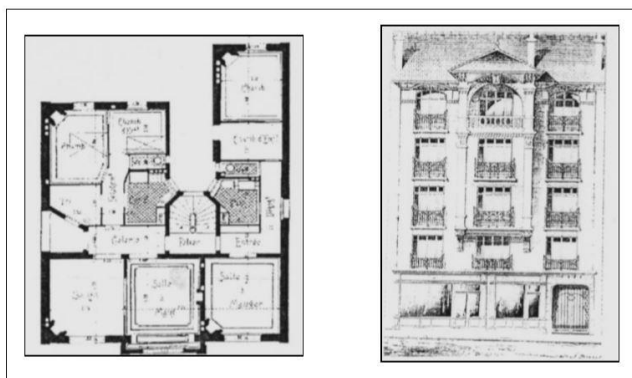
Plan et façade d'une petite maison de rapport à Clamart, A.Monod, architecte1908
